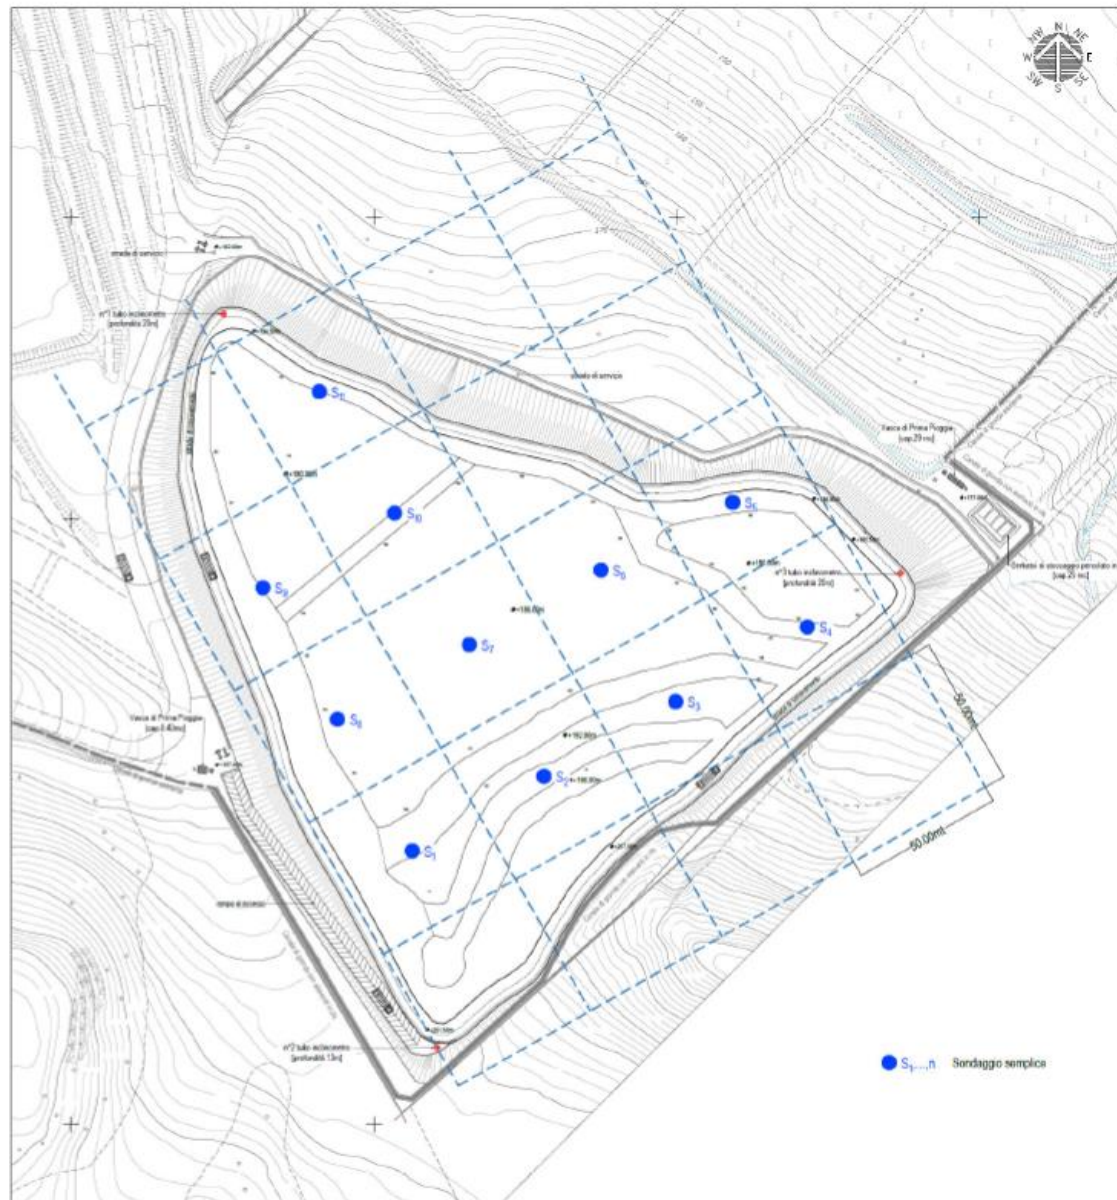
Planimetria con ubicazione indicativa punti di prelievo
